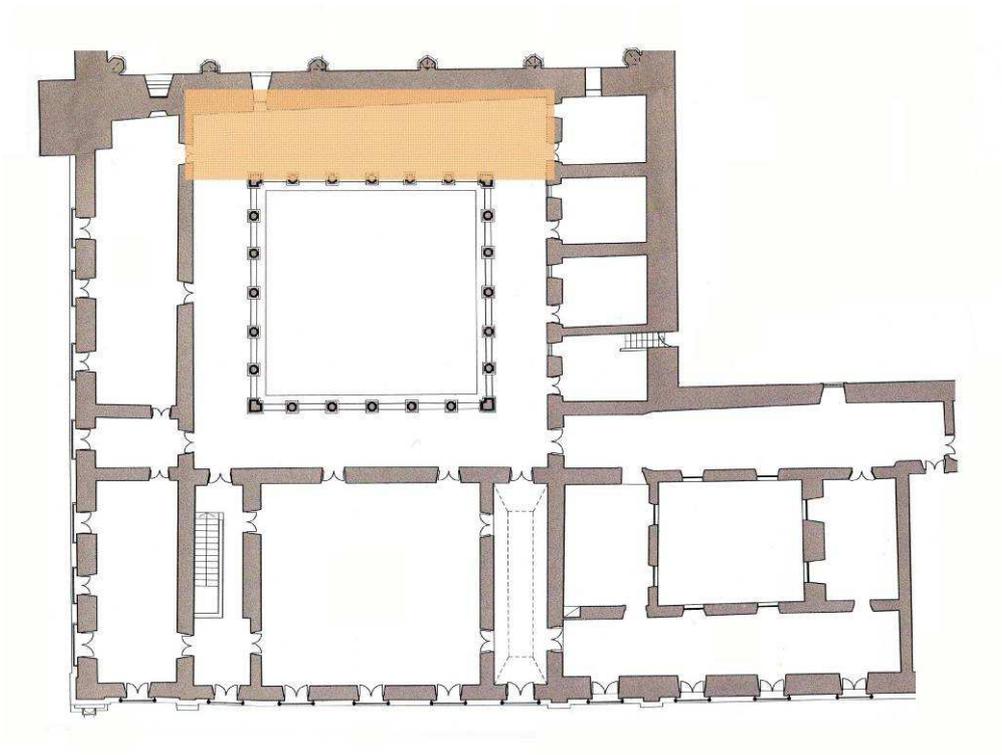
Localização da galeria Nascente na planta do piso superior do levantamento de 2003.
